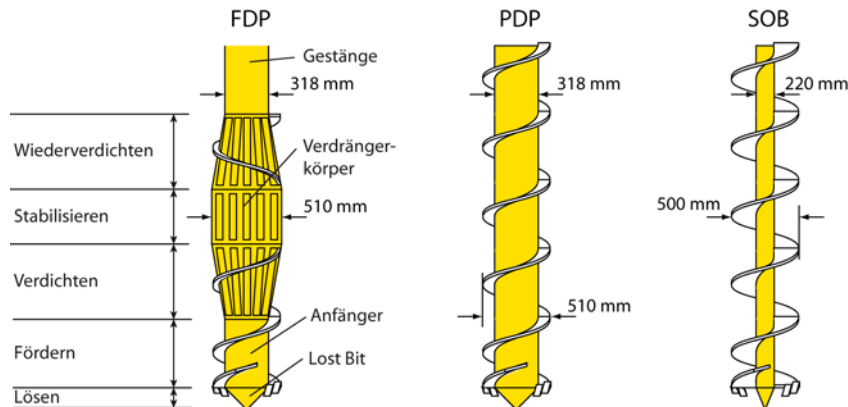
Auf dem Versuchsfeld eingesetzte Bohrwerkzeuge
